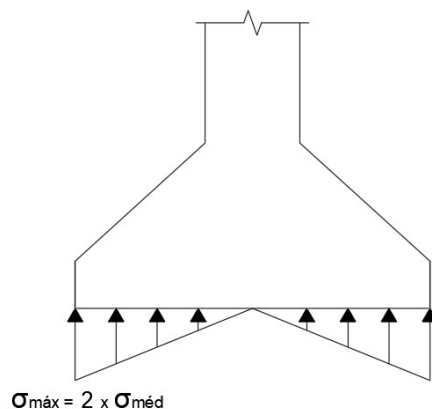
Distribuição de pressões de fundações apoiadas em rochas
